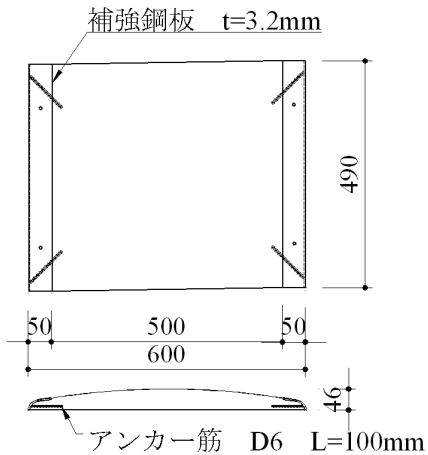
試験体 No.3 の形状 (単位 mm)
